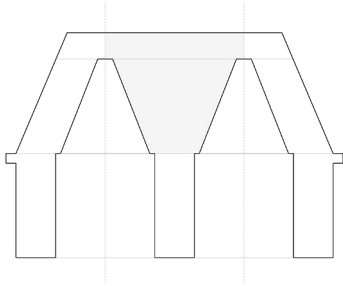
Geometría de las semibóvedas centrales en un edificio de dos crujías.
